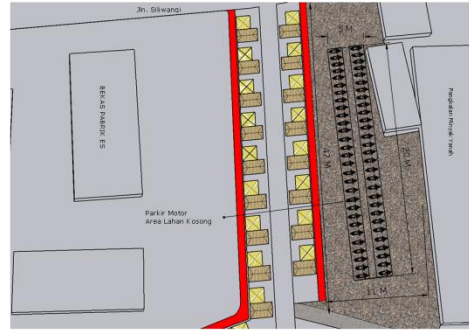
Penataan Ruang Konsumen & Ruang Lapak PKL
